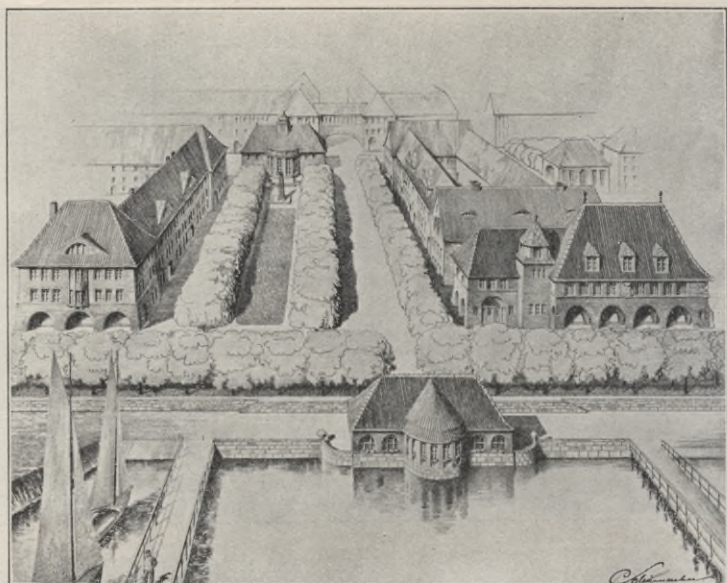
u. 35. Skizze zum Bebauungsplan eines Wohnquartiers in Sinkenwärder. Oben: Studie zum Platz am Hafen.
